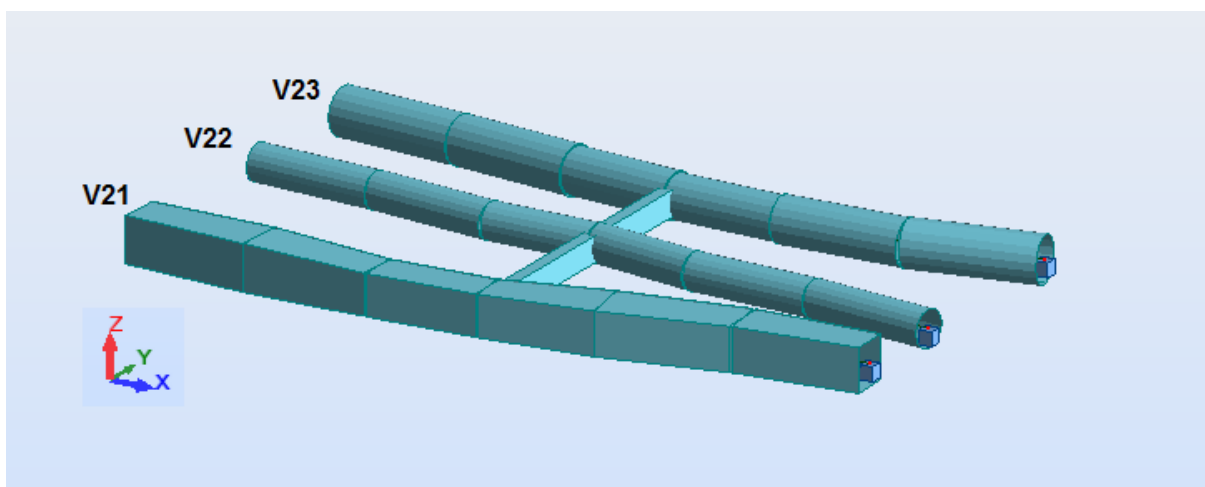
Aspeto do modelo do pavimento do piso 2
